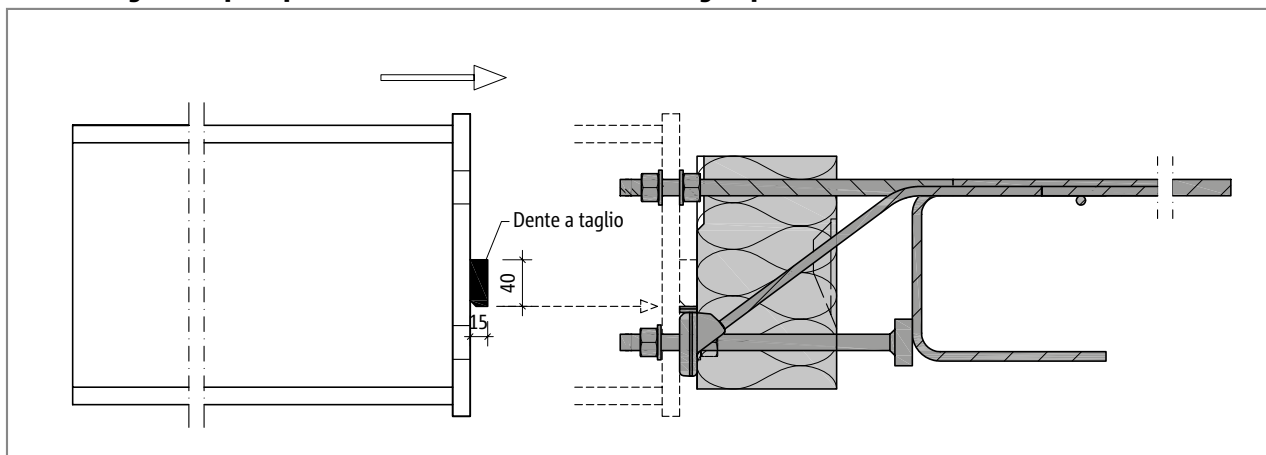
Schöck Isokorb® XT tipo SK: posa della trave in acciaio
